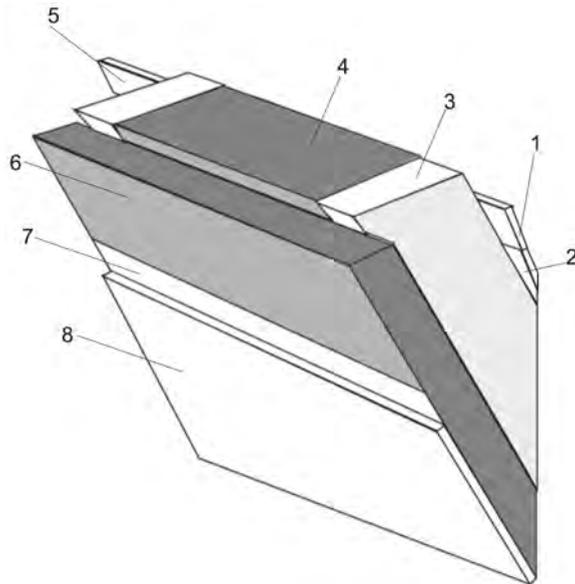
Теплоизоляция скатов крыши под стропилами: 1 — кровельное покрытие; 2 — вентилируемый зазор; 3 — стропила; 4 — межстропильная теплоизоляция; 5 — подкровельная гидроизоляция; 6 — дополнительная внутренняя теплоизоляция; 7 — парозащитная мембрана; 8 — внутренняя обшивка
